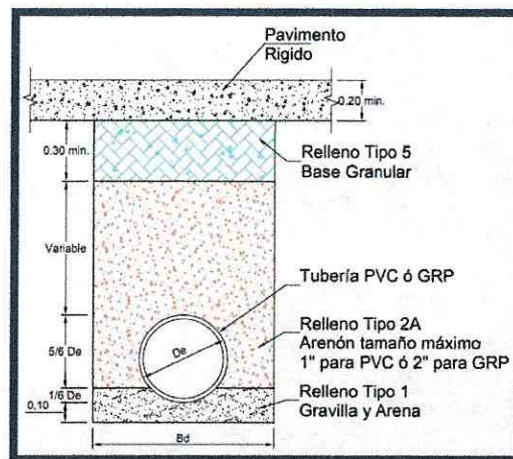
Cimentación típica de tubería para vías de pavimento rígido
